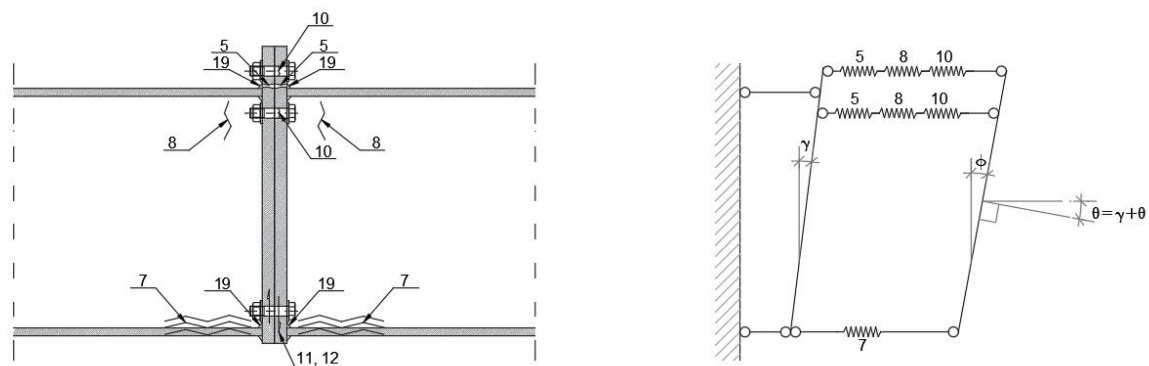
Identificação de componentes activos e modelo idealizado da junta de ligação viga/viga
